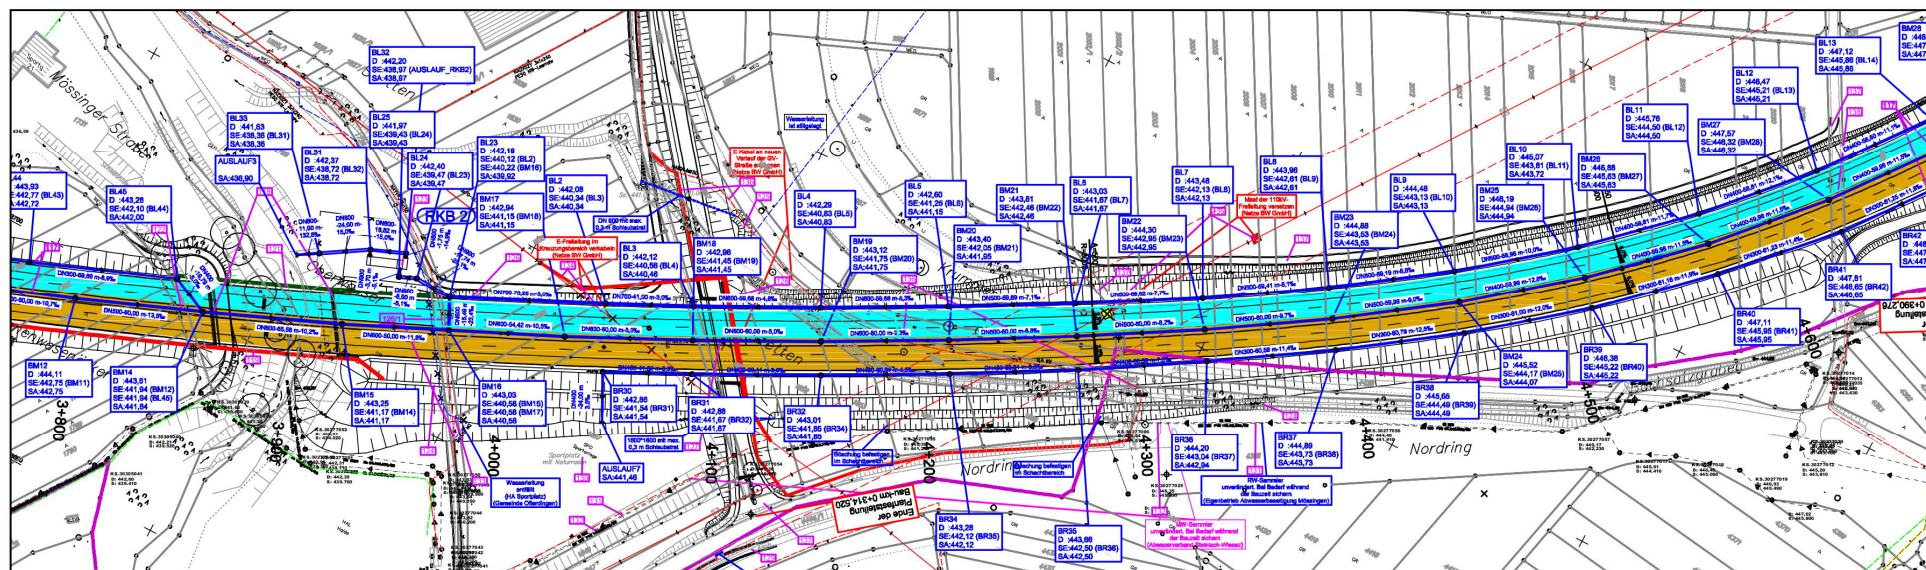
Entwässerungsabschnitt 2: Stationen 3+800 bis 4+600. Straßenflächen mit erforderlicher Behandlung (Flächen, die nicht breitflächig in den Böschungen zur Versickerung gebracht werden können). Ohne Maßstab
